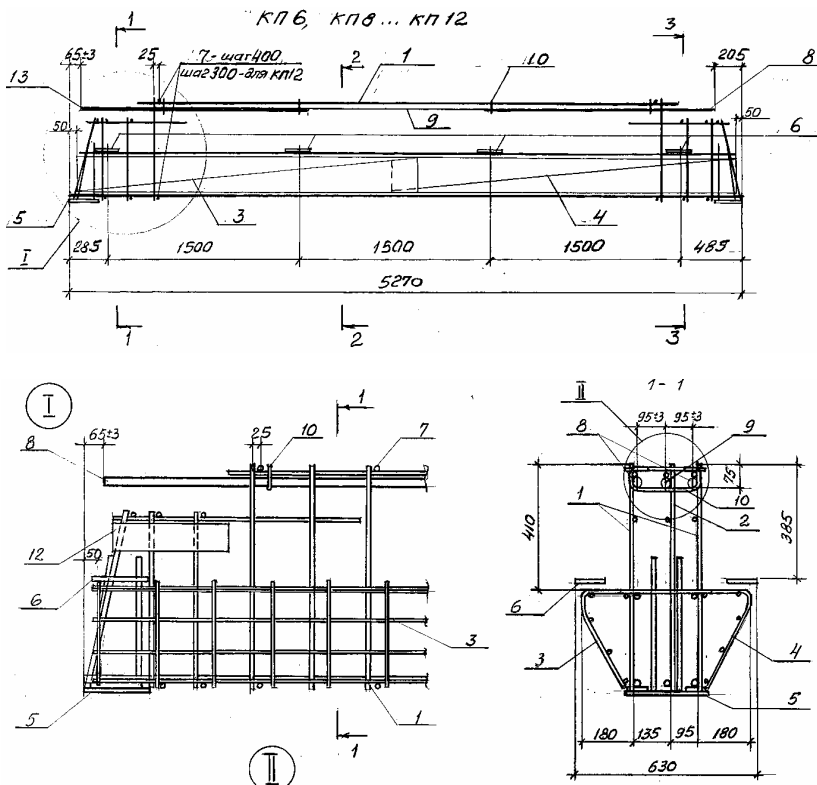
Пространственный каркас ригеля: 1, 2 – плоские каркасы с нижней продольной и поперечной арматурой; 3, 4 – гнутые сетки армирования полки; 5 – опорная закладная деталь с анкерными стержнями; 6 – закладная деталь для плит покрытий; 7 – соединительные стержни пространственного каркаса; 8, 9 – стыковые стержни дополнительного плоского каркаса; 10 – поперечные стержни дополнительного каркаса, с помощью которых он крепится к пространственному каркасу; 11 – поперечные стержни опорной зоны (см. рис. 4.11); 12 – закладная деталь для крепления дополнительных хомутов стыковой зоны; 13 – стыковой плоский каркас
